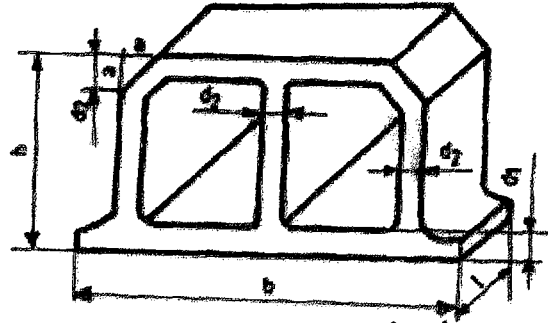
Bimsbetondan mamûl boşluklu duvar blokları [21]
